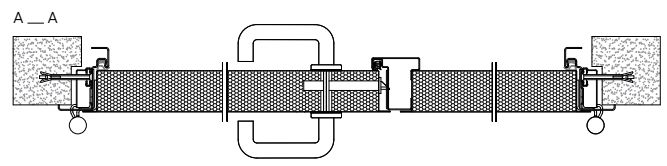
Coupe horizontale (à la hauteur de la serrure) d'un bloc-porte en tôle d'acier ECO plein, à deux battants avec bâti
